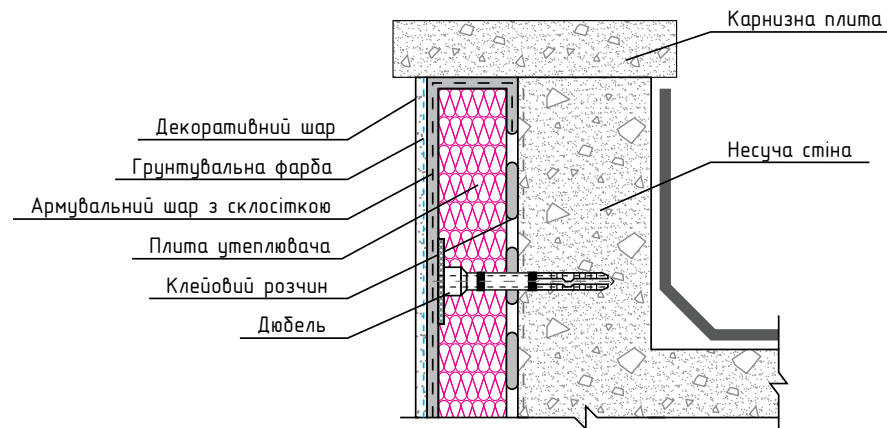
Влаштування теплоізоляції на останньому поверсі в будівлі з плоским дахом
